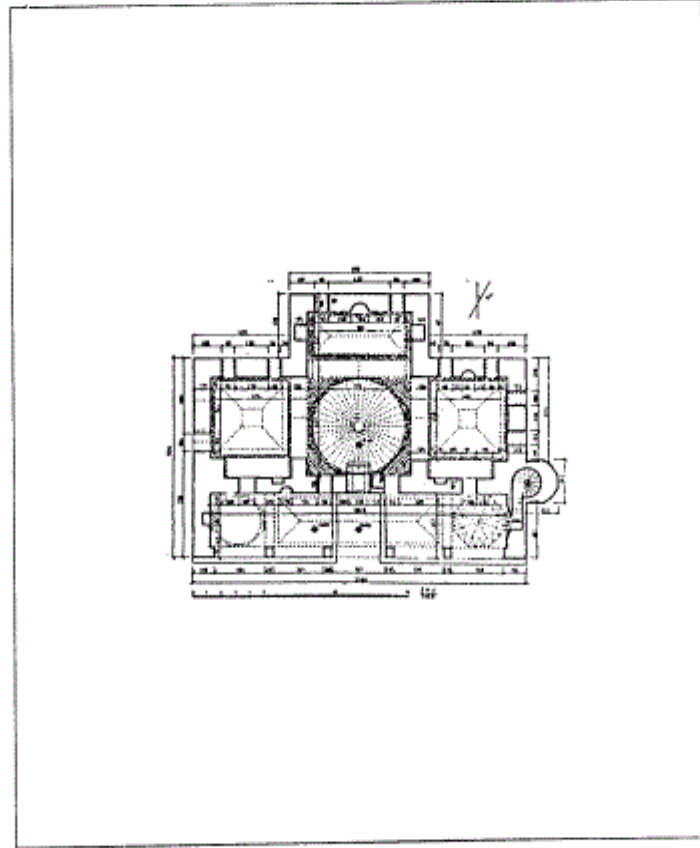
مسقط أفقي لمسجد البيلربى في أدرنة (عن : اصلان ابا)
